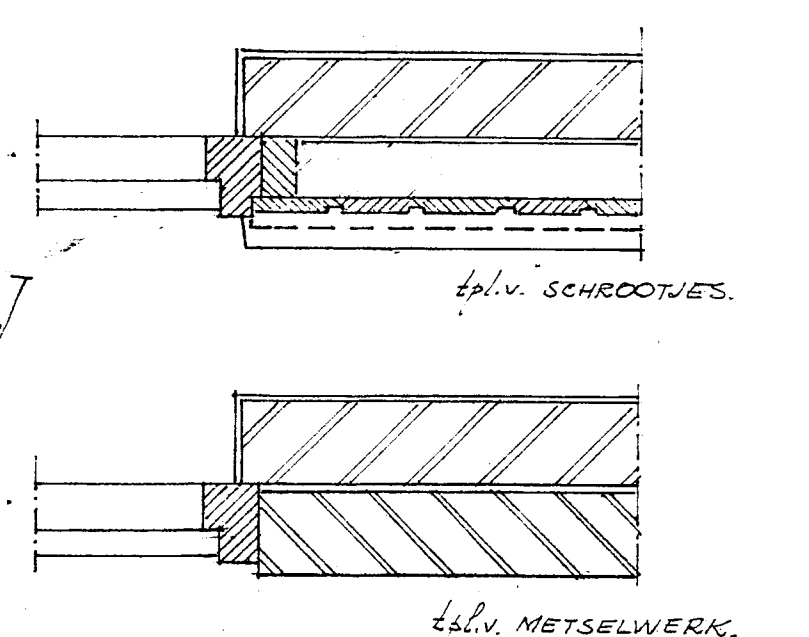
[3^A MET BALKLAAG ALS DET. 2.]
